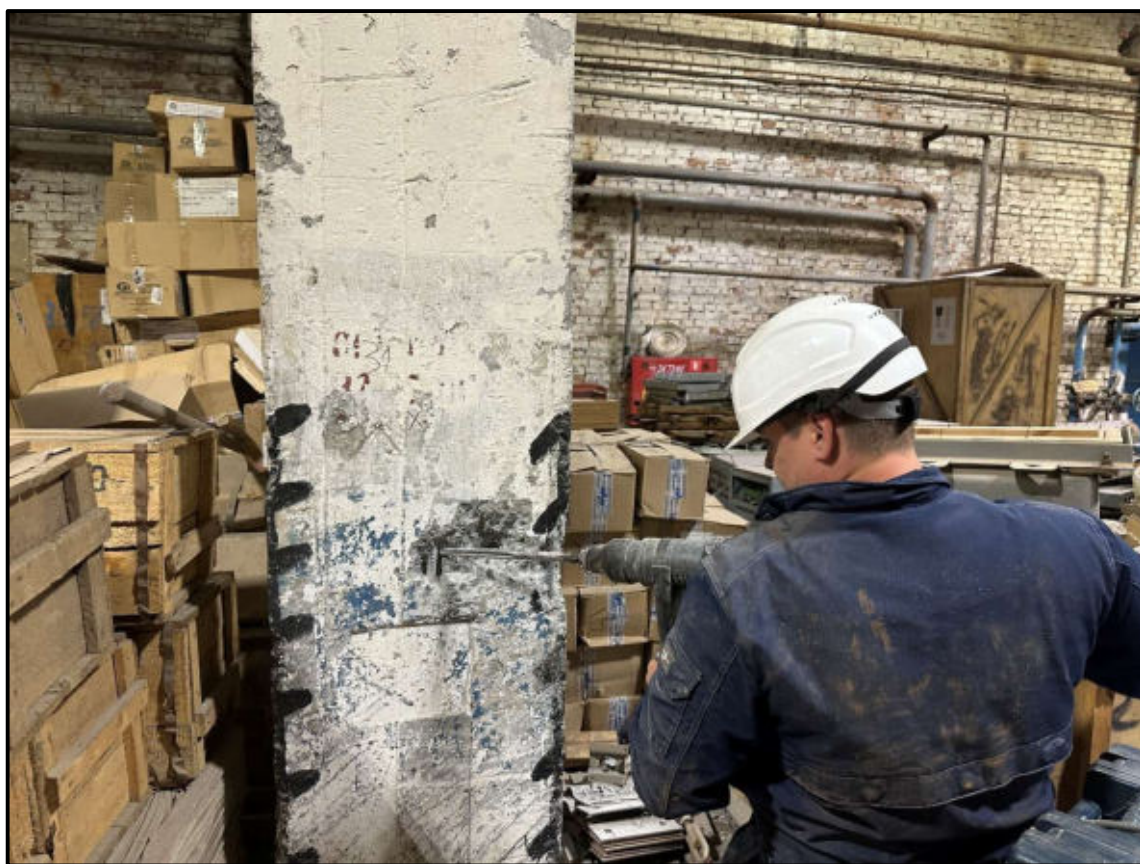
Вскрытие защитного слоя бетона колонн каркаса
